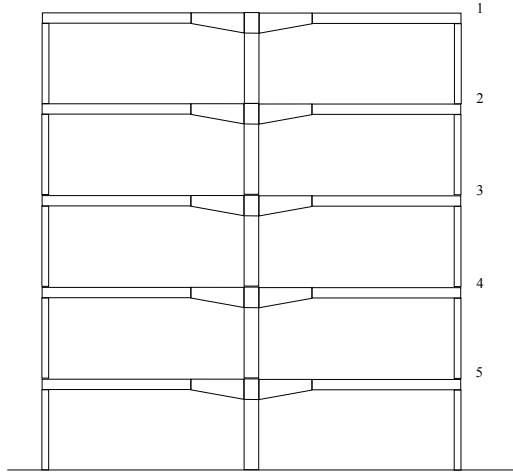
Pórtico de cinco plantas con vigas acarteladas
